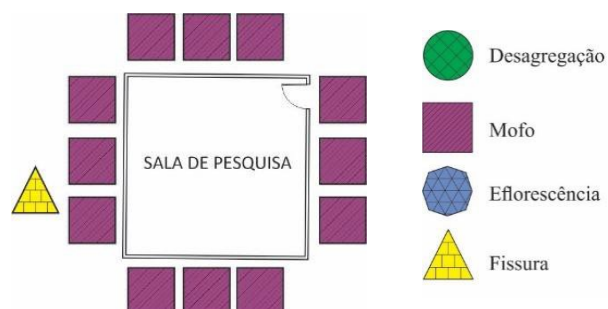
Planta Módulo – Mapeamento de Danos Fonte: Autora
